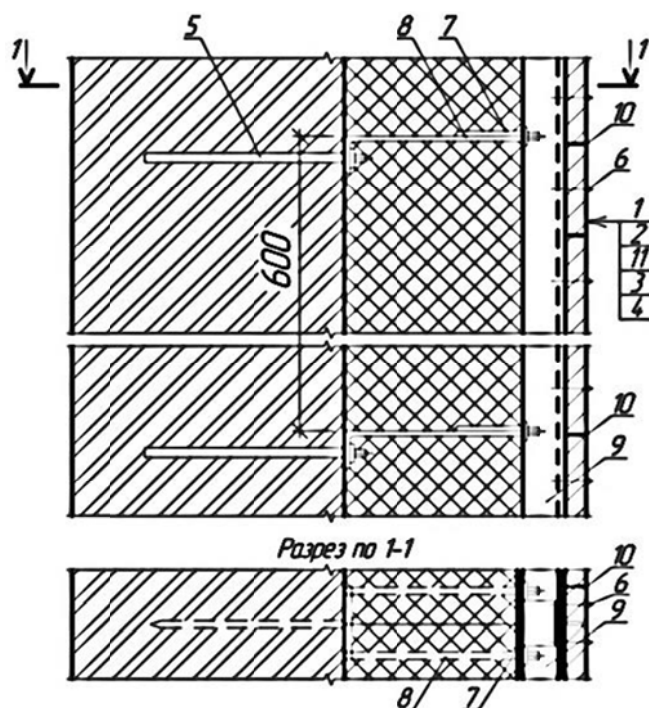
Конструкция вентилируемой системы фасада:
